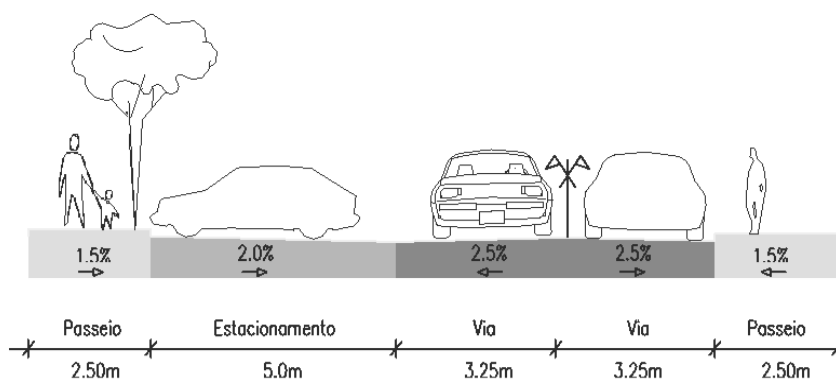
Perfil Transversal Tipo 5 – Eixos 7 e 8
